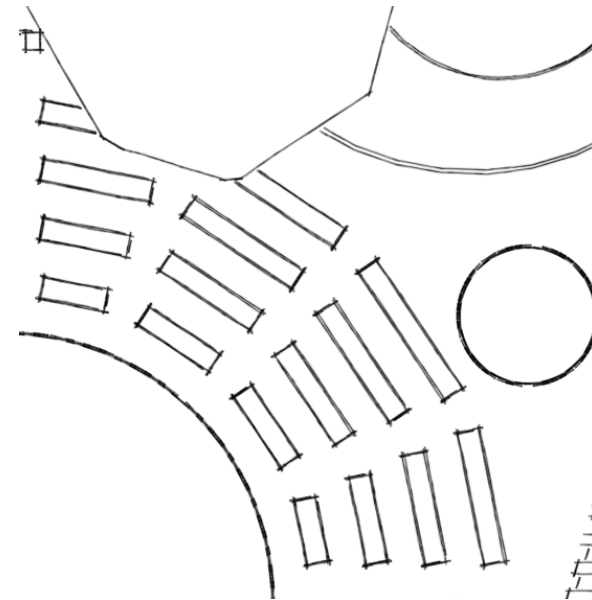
Vista en planta del teatro al aire libre. (Hernández Reyes, 2021).
